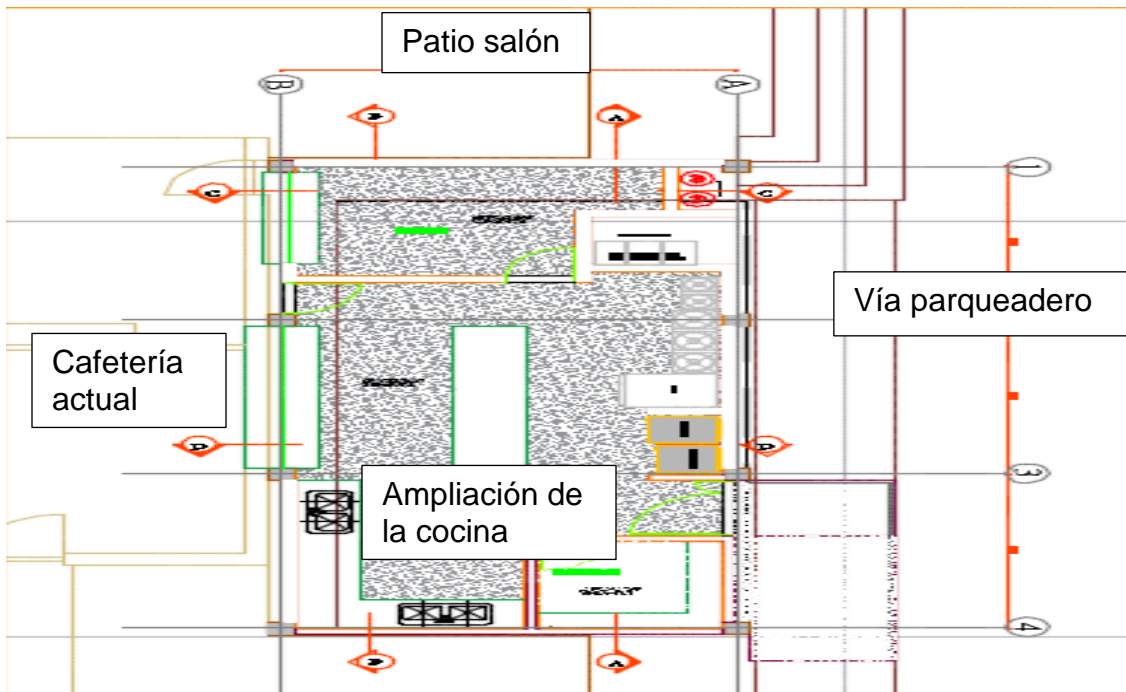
Plano en planta de la proyección de la ampliación del comedor.
